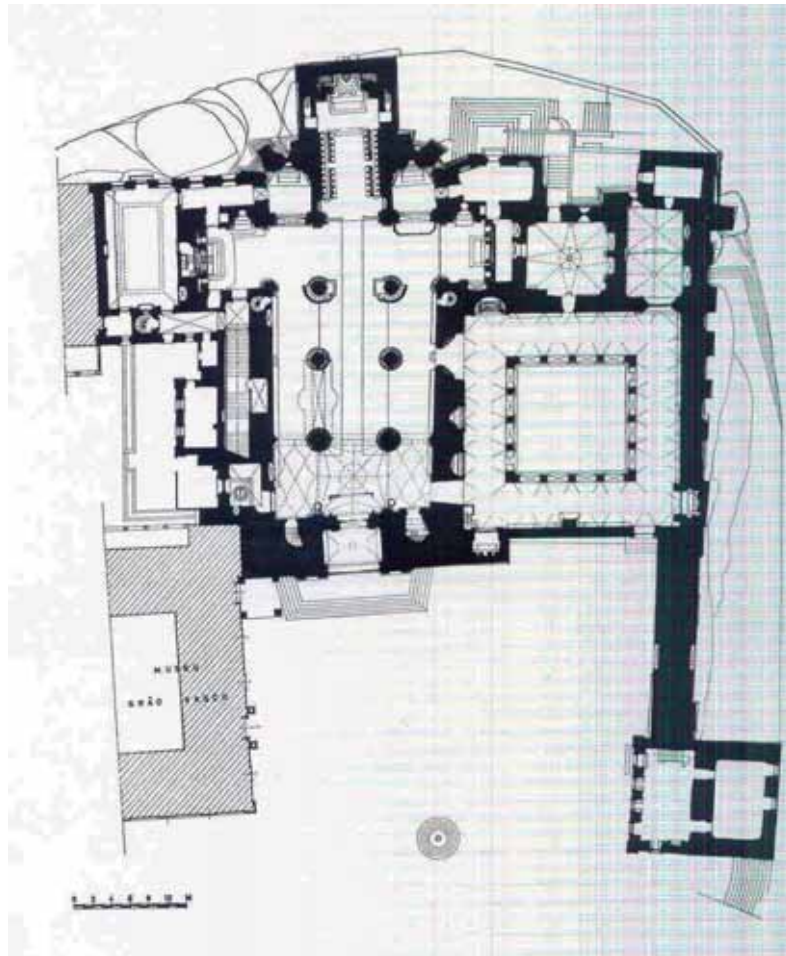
Planta de la Catedral de Viseu antes de las obras de restauración. IHRU
